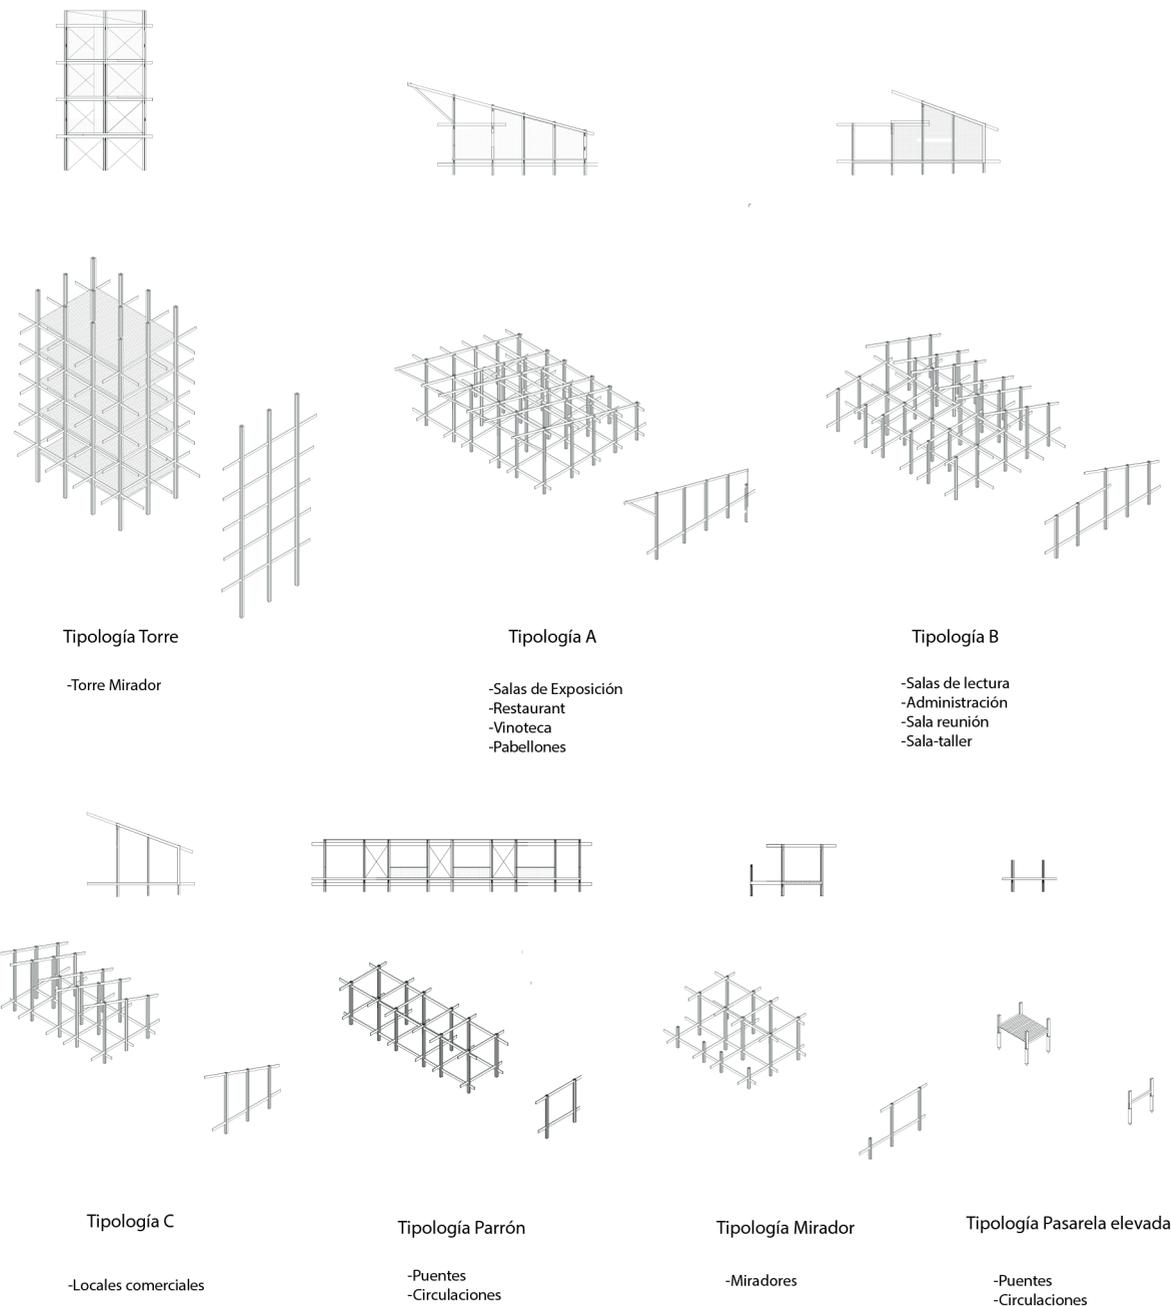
Catálogo de módulos constructivos. Fuente: Elaboración propia
